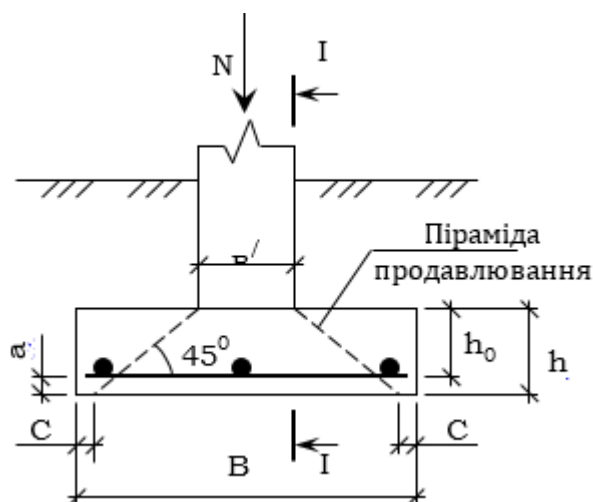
Схема для розрахунку конструкції центрально навантаженого фундаменту
